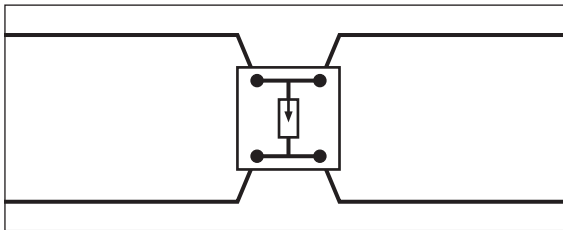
SPD mit Durchgangsverdrahtung
